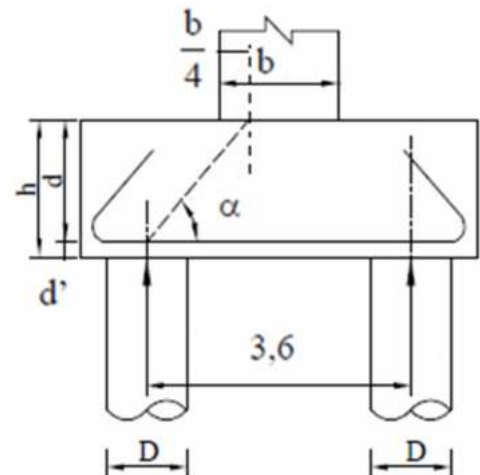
Schéma représentant coupe transversale sur la semelle
